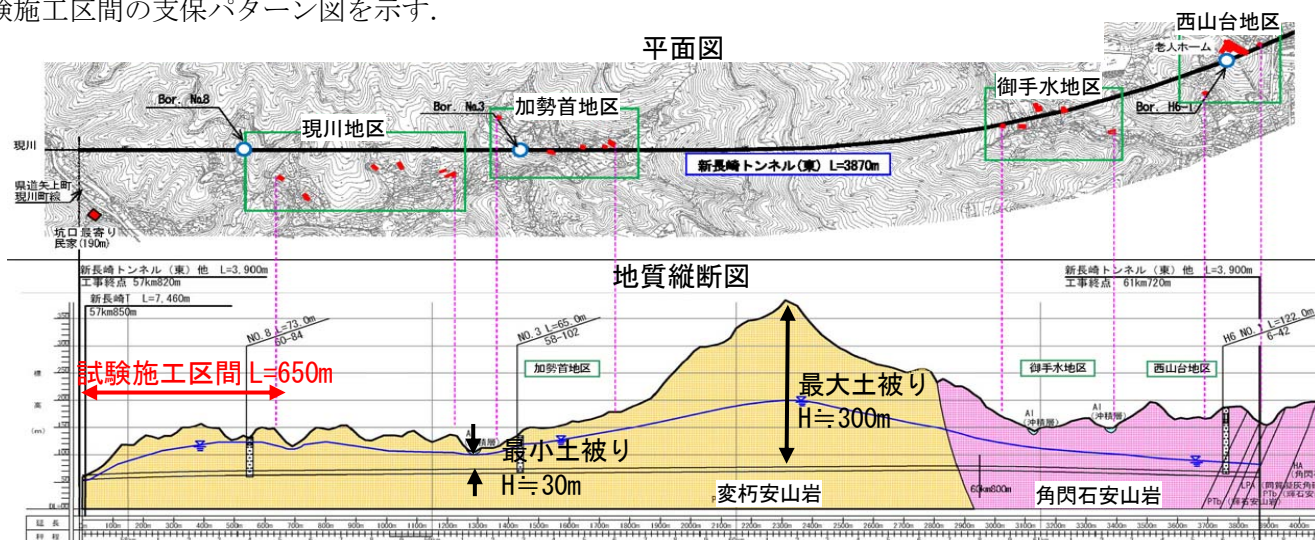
九州新幹線（西九州）新長崎トンネル（東）他工事 地質縦断面図及び平面図
